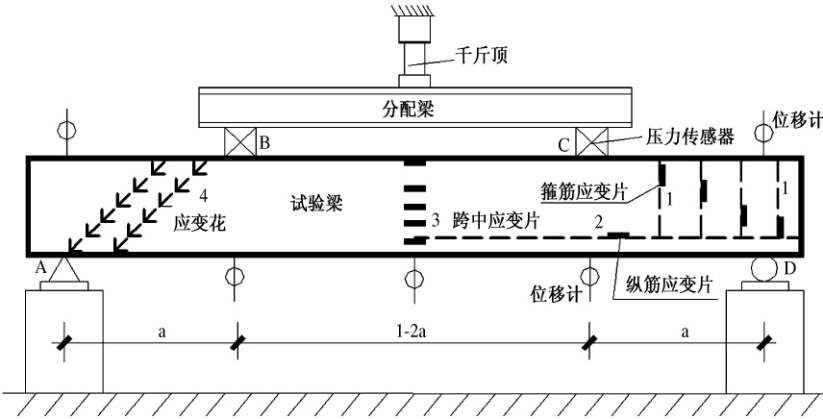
试件加载及钢筋应变片和混凝土应变花布置示意图
